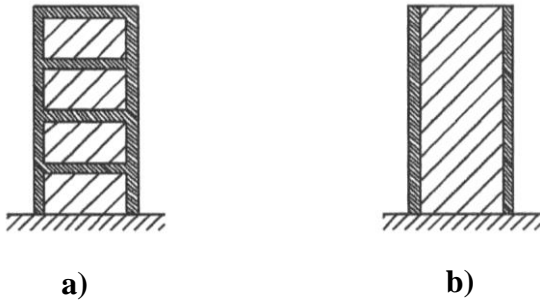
Збірні будівельні системи. Збірні стіни: а) Тип 1 – сталева або складена рама, що сприймає моменти, із заповненням з бетонних панелей; б) Тип 2 – Збірні стіни, армовані сполученими обрамленнями з вертикальних сталевих профілів.
